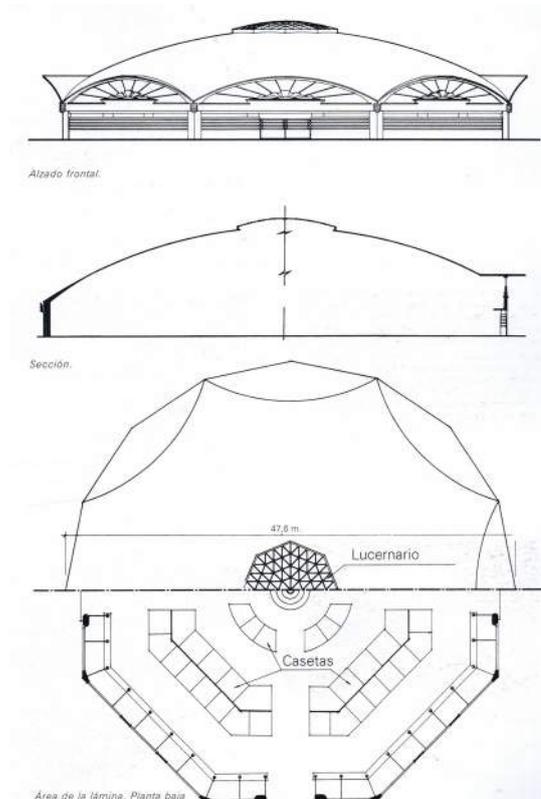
PLANTA, ALZADO Y SECCIÓN
